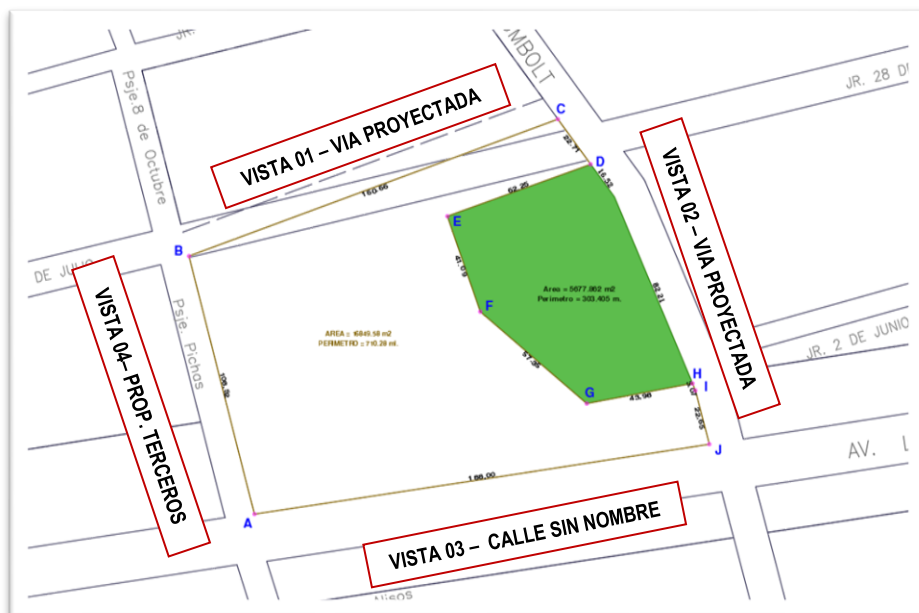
Vista de vías y accesos al predio – Plano Planta.
